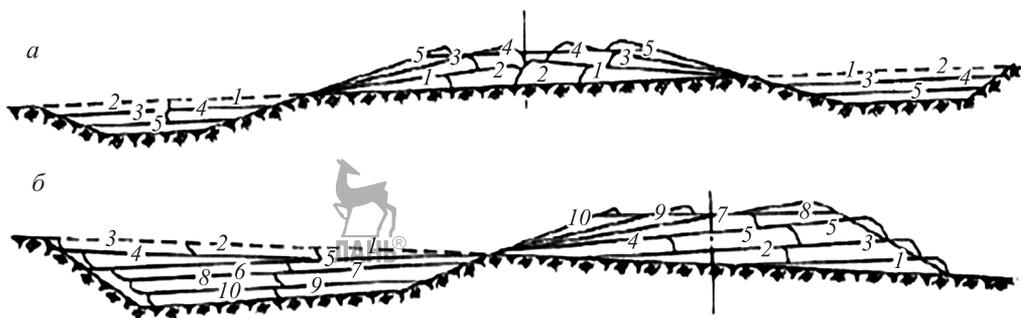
Схема разработки грунта бульдозером в резерве и перемещения его в насыпь: а – из двусторонних резервов; б – из одностороннего резерва; 1...10 – слои грунта
